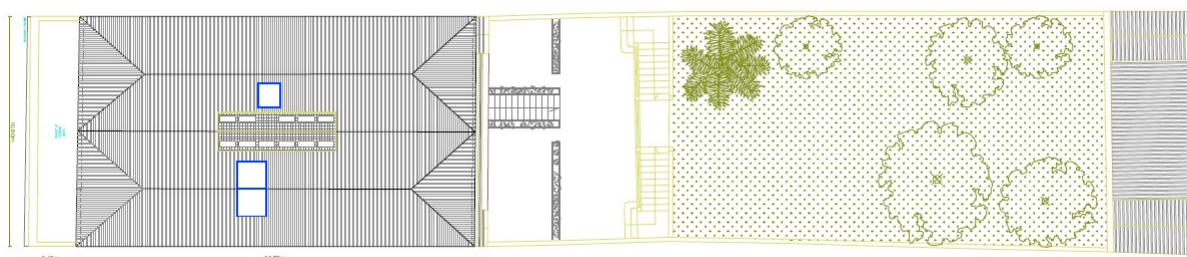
Planta de proposta de intervenção da cobertura (sem escala)
